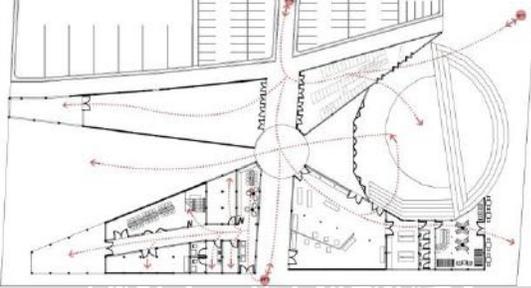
70 : Sintesa - Skematik Denah Lantai 2
